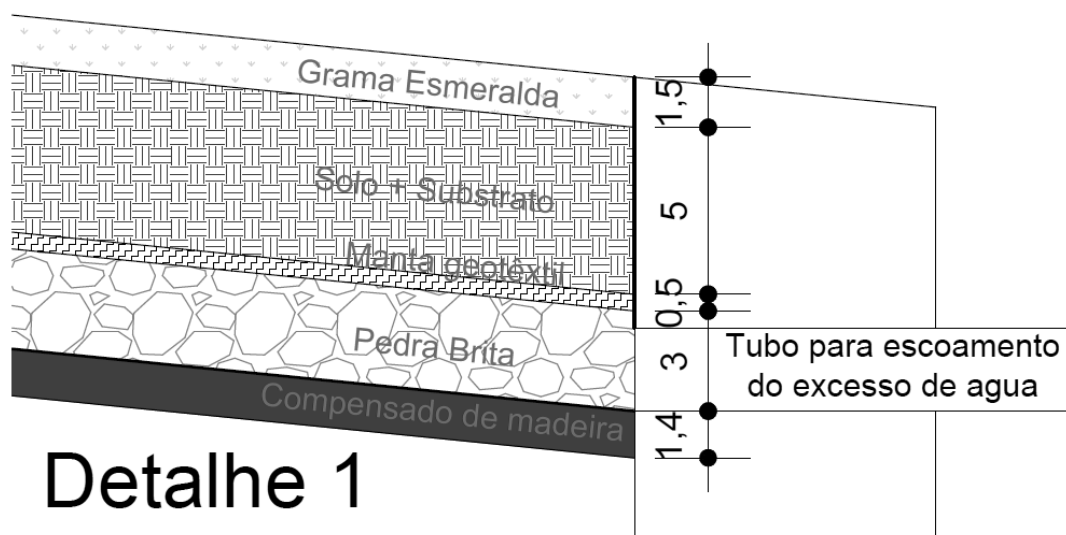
Detalhe 1 da cobertura verde (medidas em centímetros)
